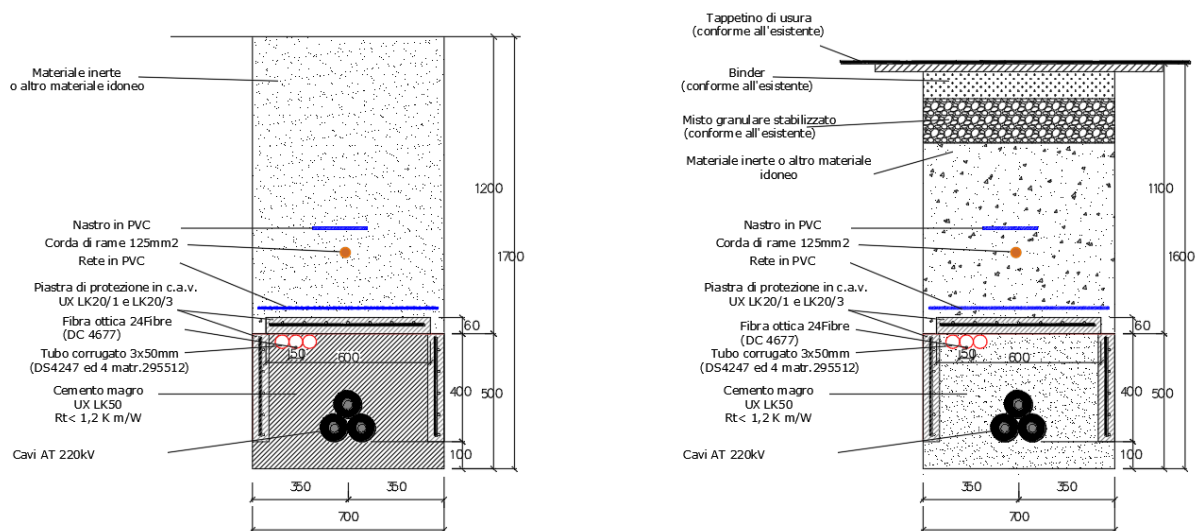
Tipico di sezione cavidotto AT su strada e su terreno agricolo
